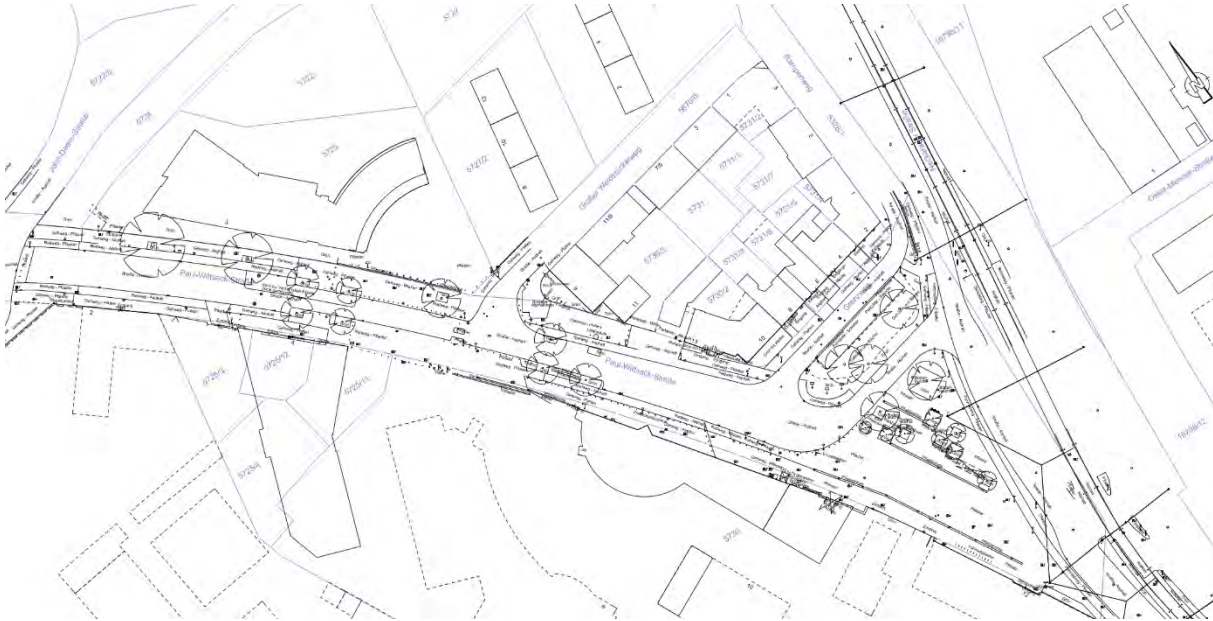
Bestand – „Paul-Wittsack-Straße“
